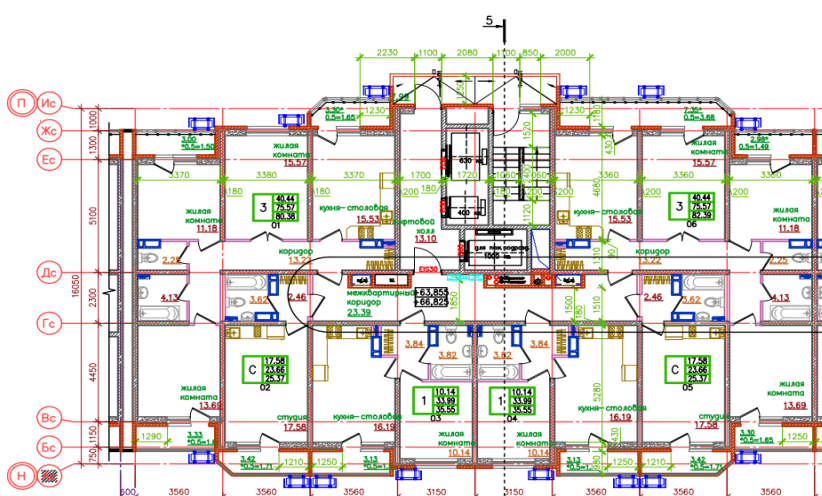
Типовой план 22-23 этажа БС-6 ЖК URAL
